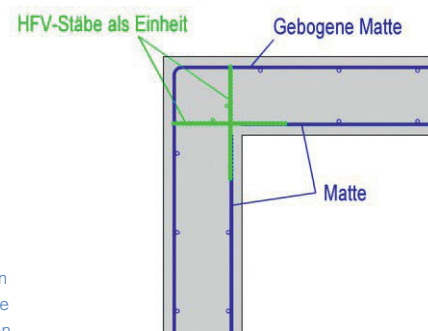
Bewehrungsführung in einer Wandecke mit HFV-Stäben
